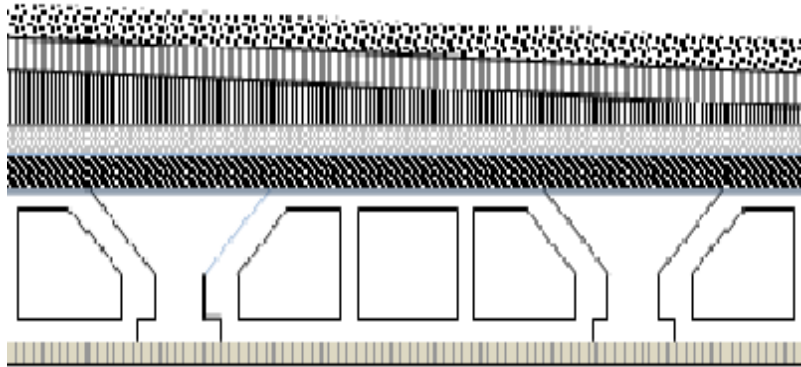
coupe verticale d'un plancher terrasse a corps creux.
